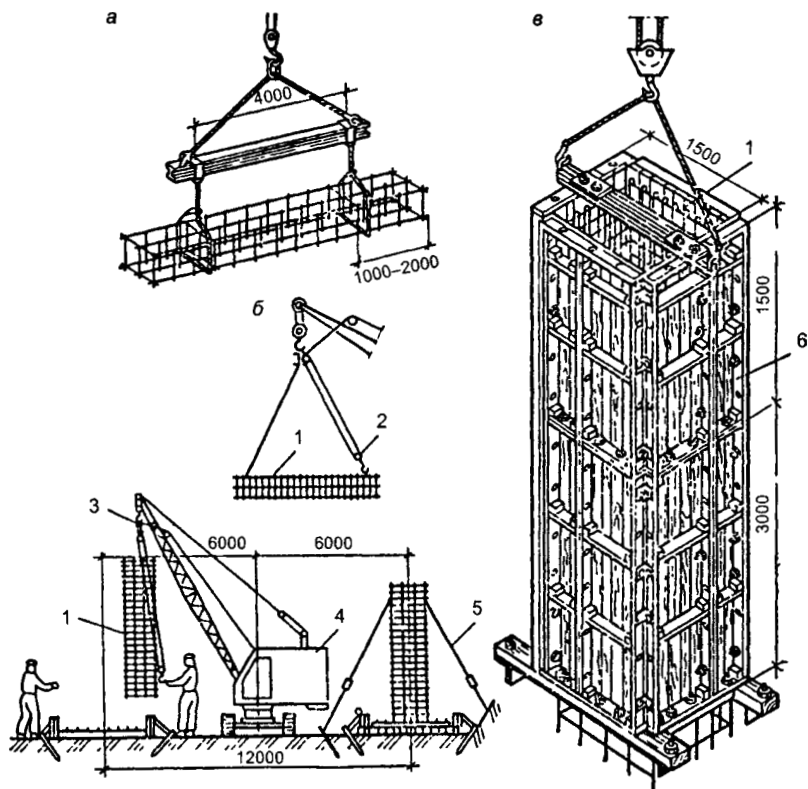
Монтаж арматурных каркасов и арматурно-опалубочных блоков:
